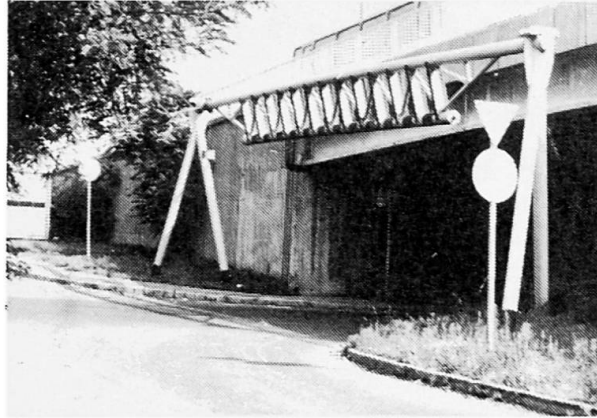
Portal mit ausschlagender Stahlkonstruktion
